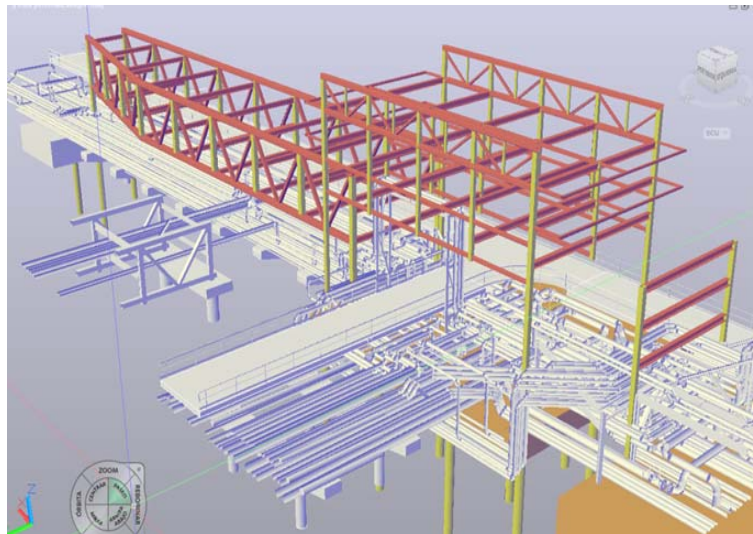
Modelado del nuevo rack estructural. 2015. Acciona Ingeniería
